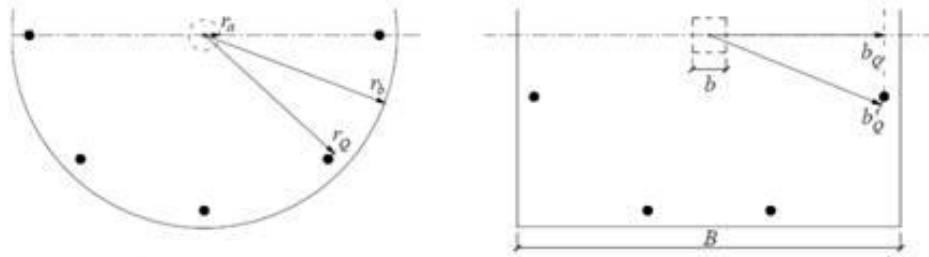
Geometria de uma laje circular e de uma laje quadrada [3]
